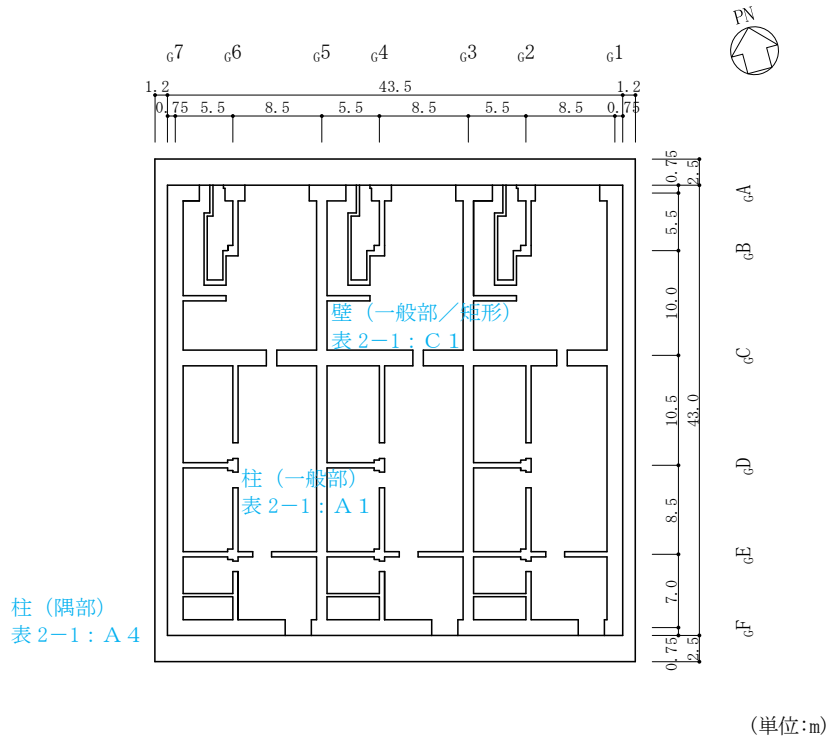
(1) ガスタービン発電機建物の概略平面図 (EL 47.5m)
